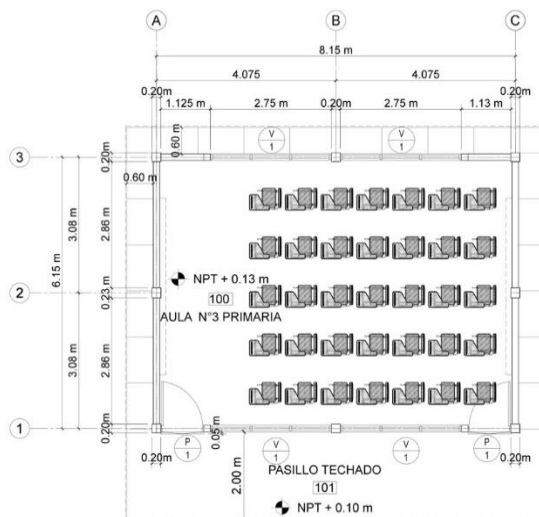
Planta Arquitectónica del Pabellón 3, Fuente: Área de Preinversión MINED
